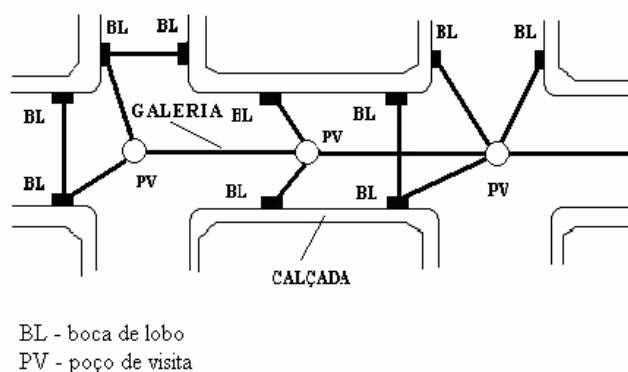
Esquema da disposição dos elementos de uma galeria
